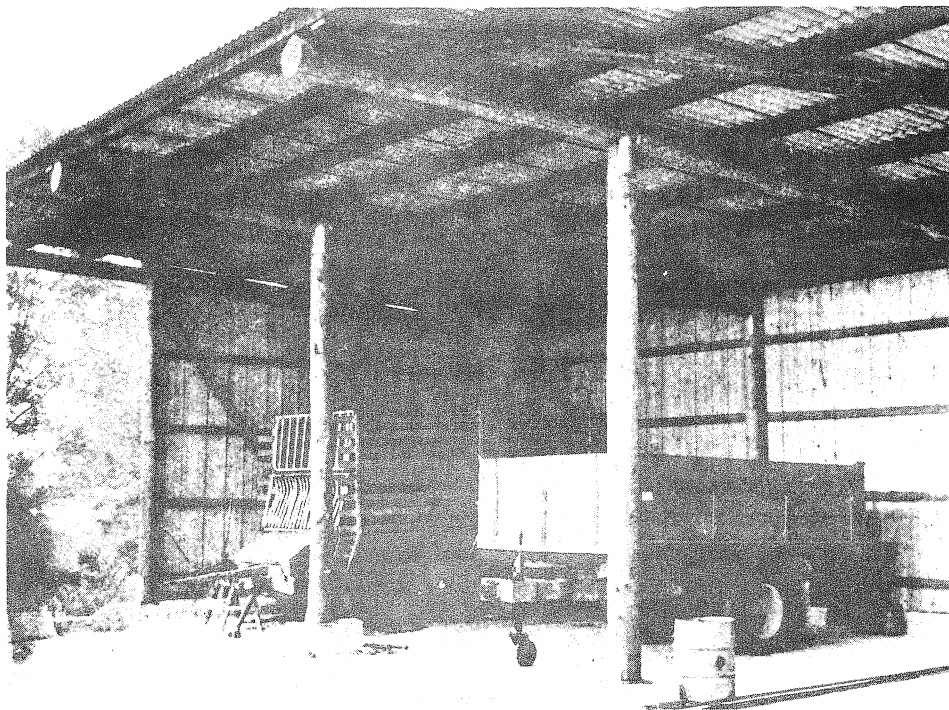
Pultdach. Maschinenhalle aus Rundholz und Rundholzverbindern. Billig und zweckmäßig zugleich, werden solche auch als Lagerhalle oder Jungviehlaufstall nutzbaren Rundholzkonstruktionen zur Zeit immer mehr gebaut.
